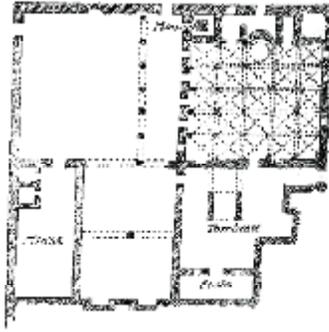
مسقط أفقي لجامع الهواء بتونس
